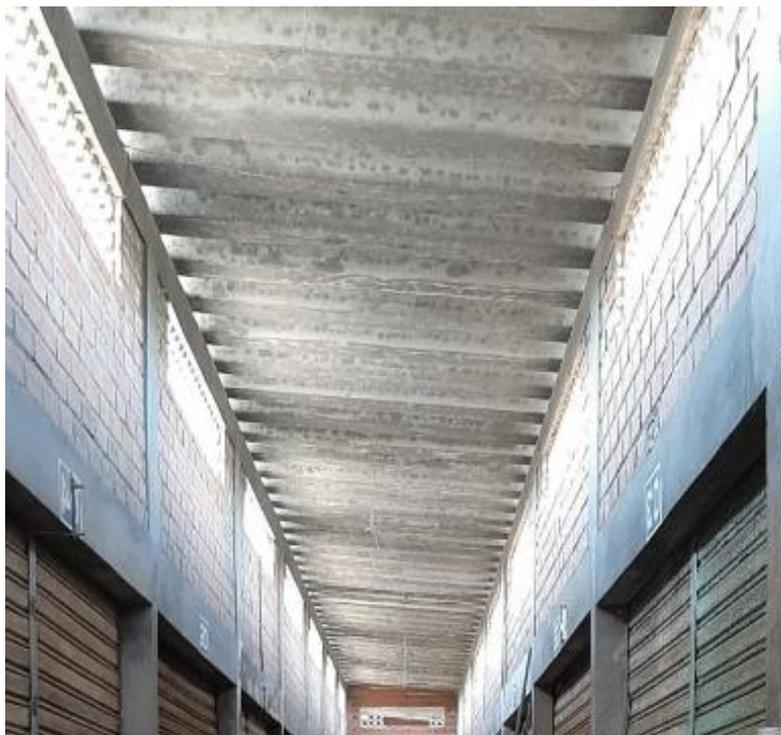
Localizada no pavilhão central e 03. Sinais de infiltração com a presença de manchas brancas e mofo.
